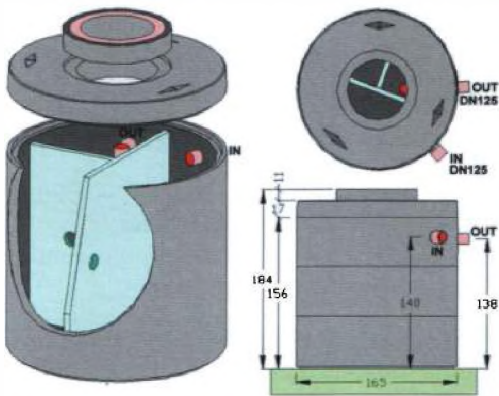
Сборный железобетонный септик. Италия. Внутреннее устройство
